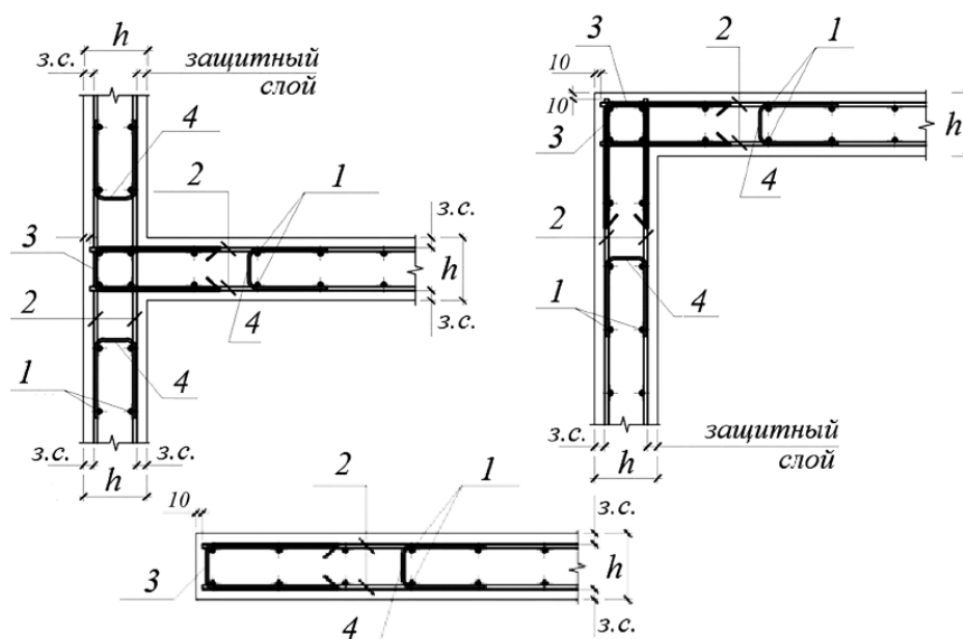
Схемы армирования несущих монолитных стен: 1 – вертикальная арматура; 2 – горизонтальная арматура; 3 – П-образные хомуты; 4 – фиксаторы-скобы из арматуры 8-А500С с шагом 600 мм в шахматном порядке
